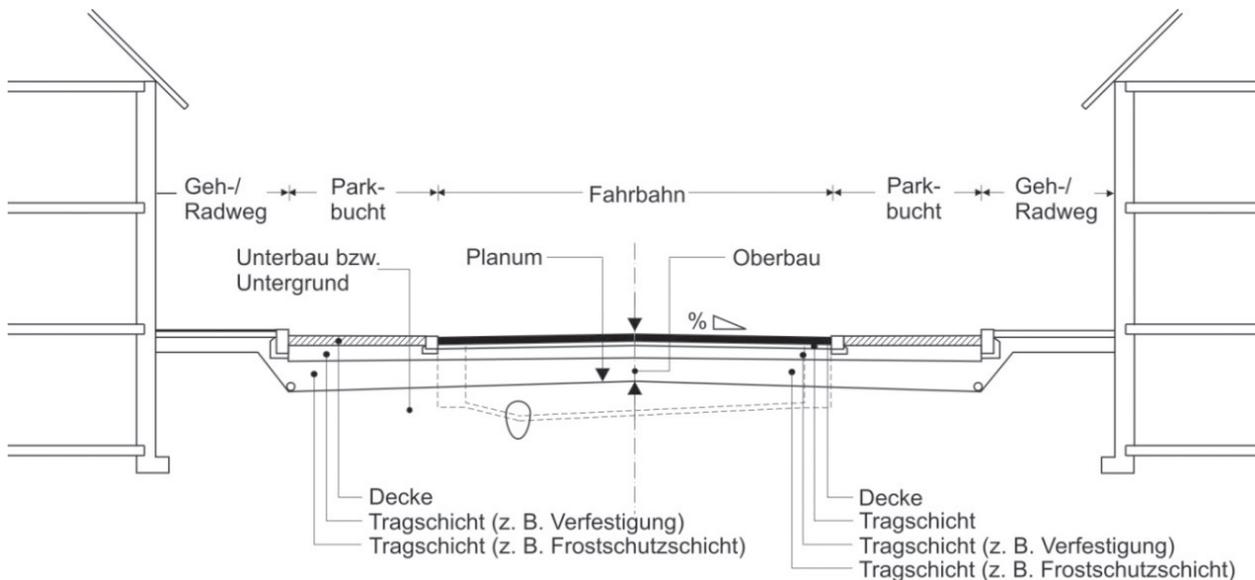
Beispielhafter Aufbau einer Befestigung in geschlossener Ortslage mit wasserundurchlässigen Randbereichen und geschlossener seitlicher Bebauung sowie mit Entwässerungseinrichtungen
